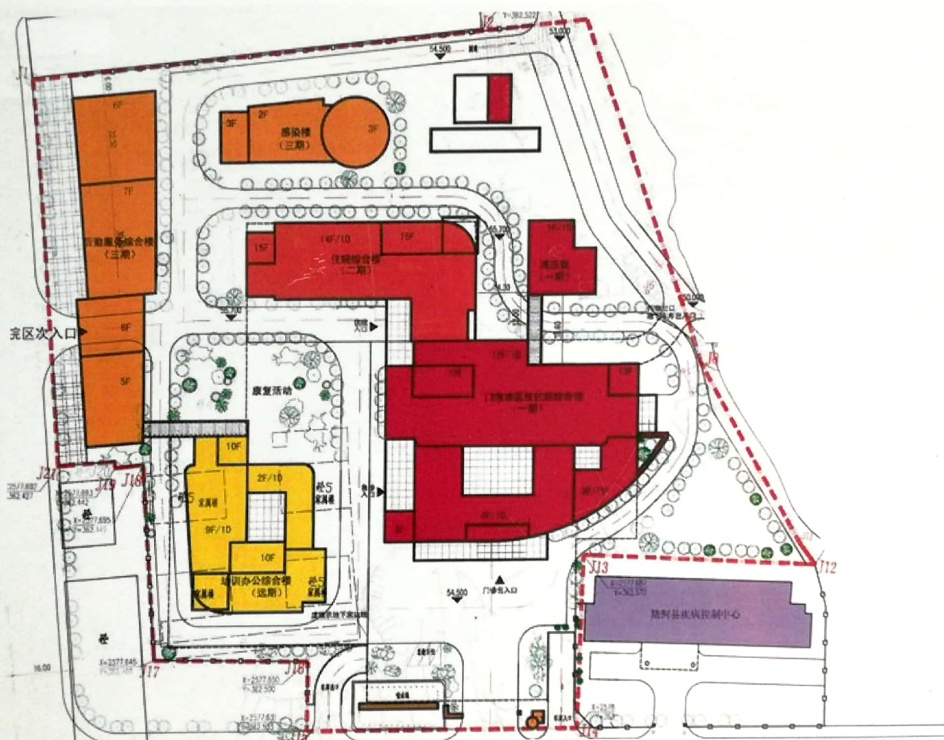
医院平面布置图 (本次验收一期工程-红色部分)
